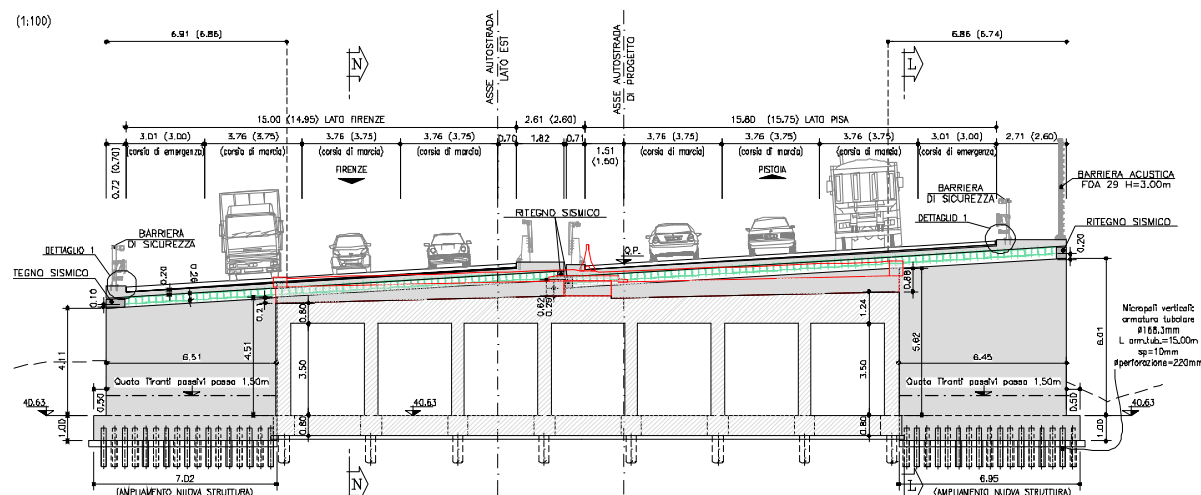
Ponte sul T. Bagnolo Bardena. Sezione trasversale
